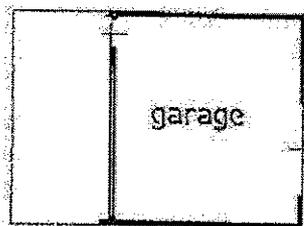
planimetria catastale, sezione A, foglio 2, mappale 52 sub 22 (fuori scala)
